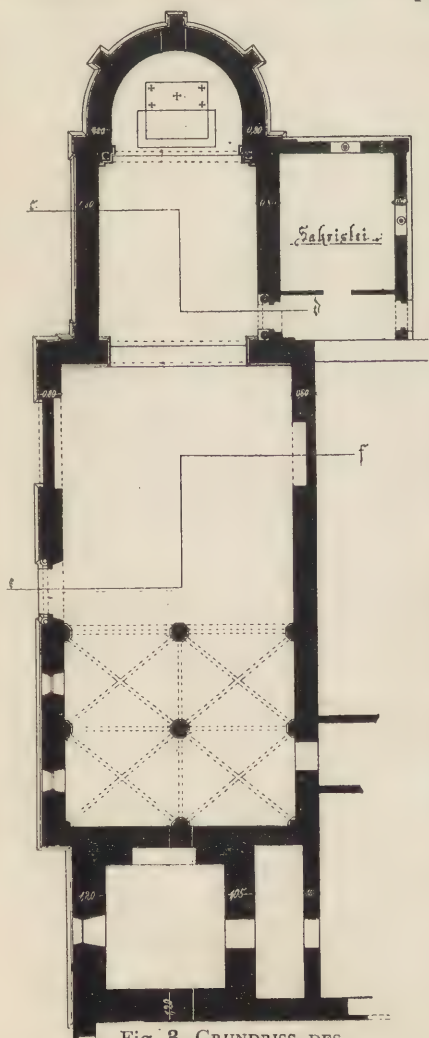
GRUNDRISS DES ERDGESCHOSSES.
